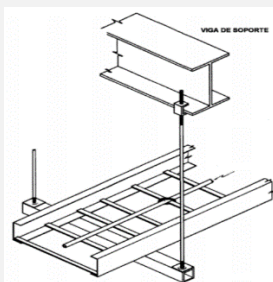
Canalização externa com calha rígido metálico Fonte: [Autor]
